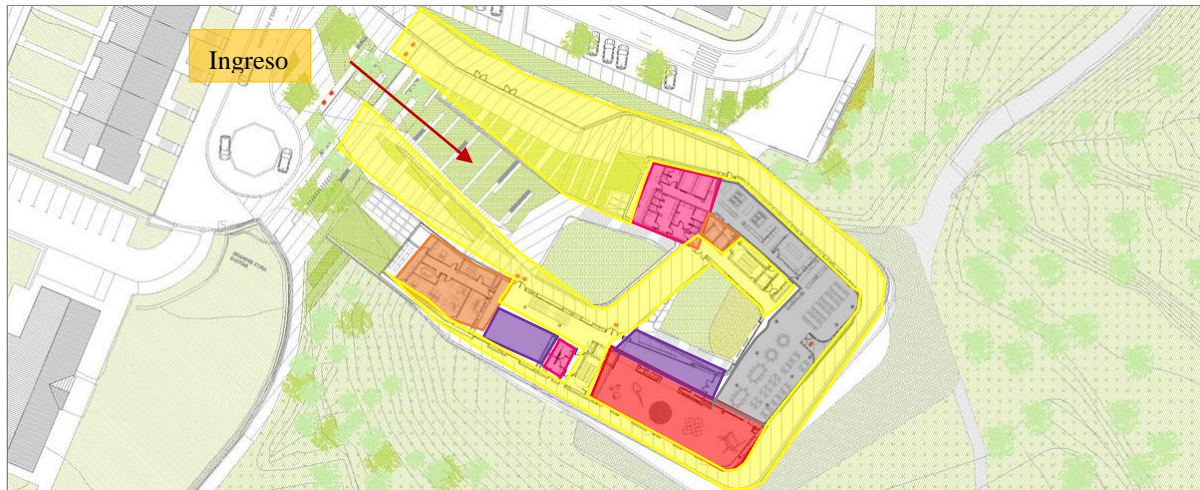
Zonificación Planta 4 (ArchDaily Perú, 2011) Elaboración Propia.
